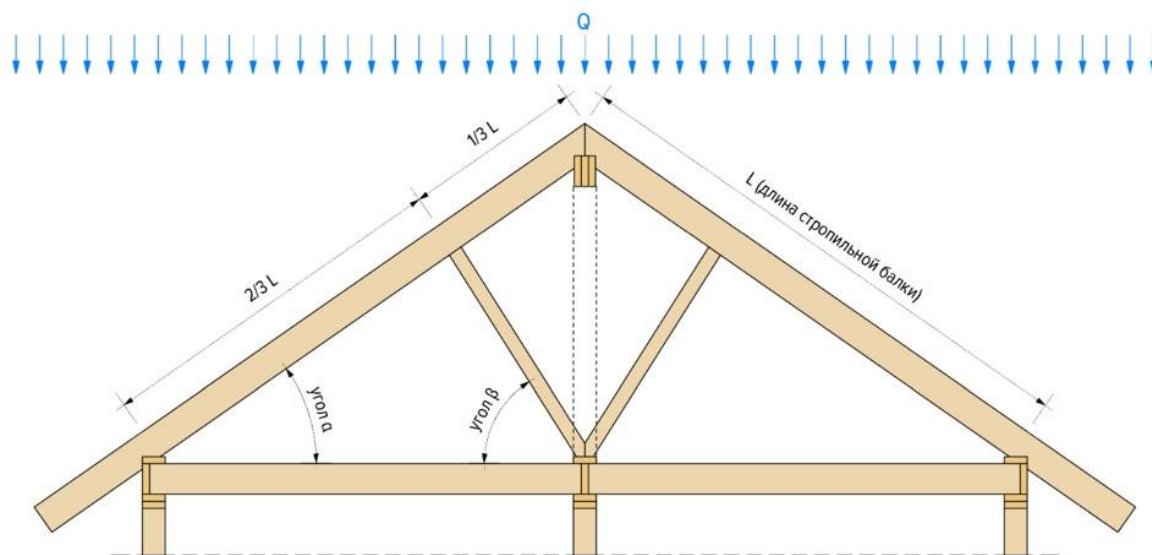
Расчётная схема наслонных стропил с подкосами
